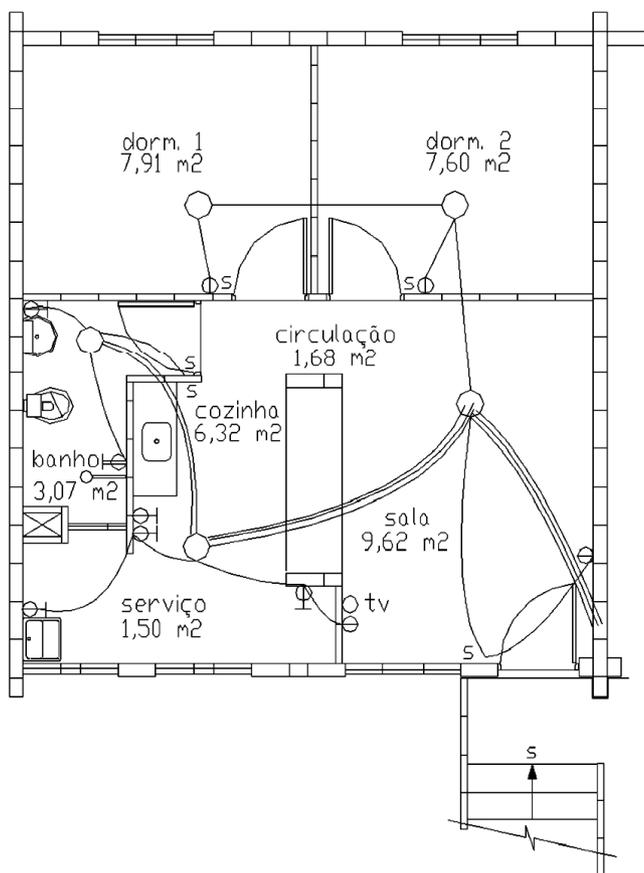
Material referencial - planta 9, apartamento padrão VG.22-A
